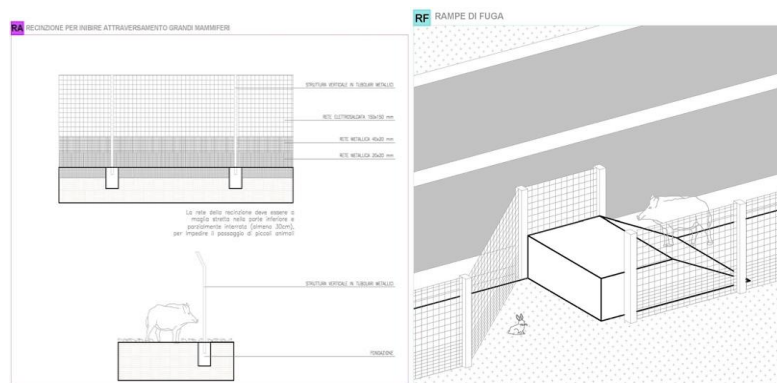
Assonometria schematica, prospetto e sezione della recinzione e delle rampe di fuga
